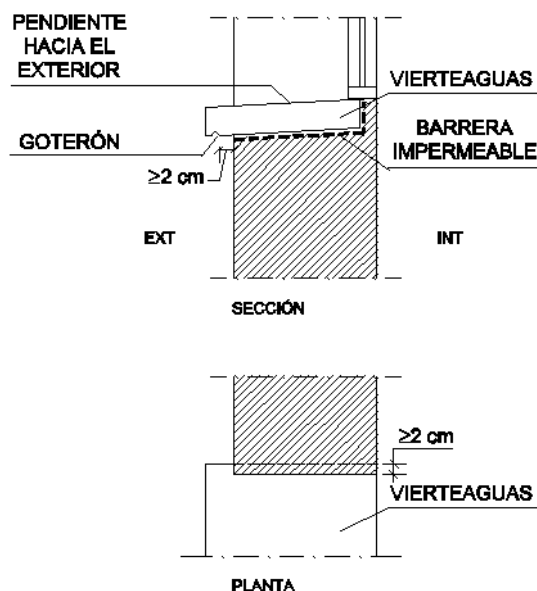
Ejemplo de encuentro de la fachada con la carpintería
